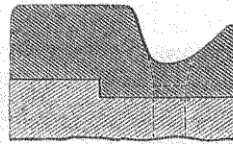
Tramways belges sur rues. Section du rail employé dans Bruxelles, 12 kil. par mètre courant. Échelle 1/5.
